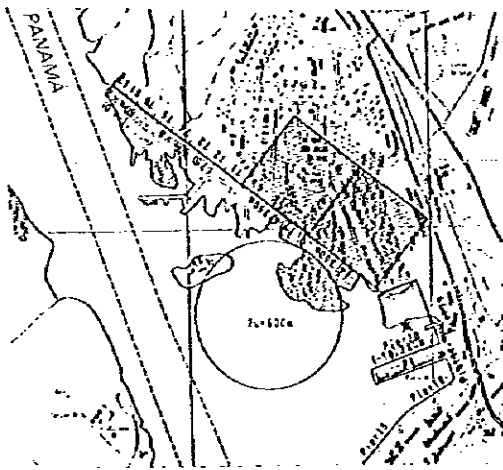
Plan Alternativo en el Distrito Diablo (D3)
